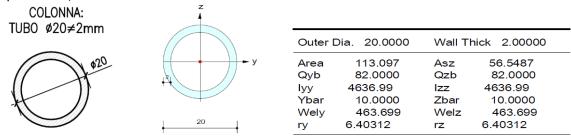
Sezione delle colonne H 100-400mm [valori in mm]
